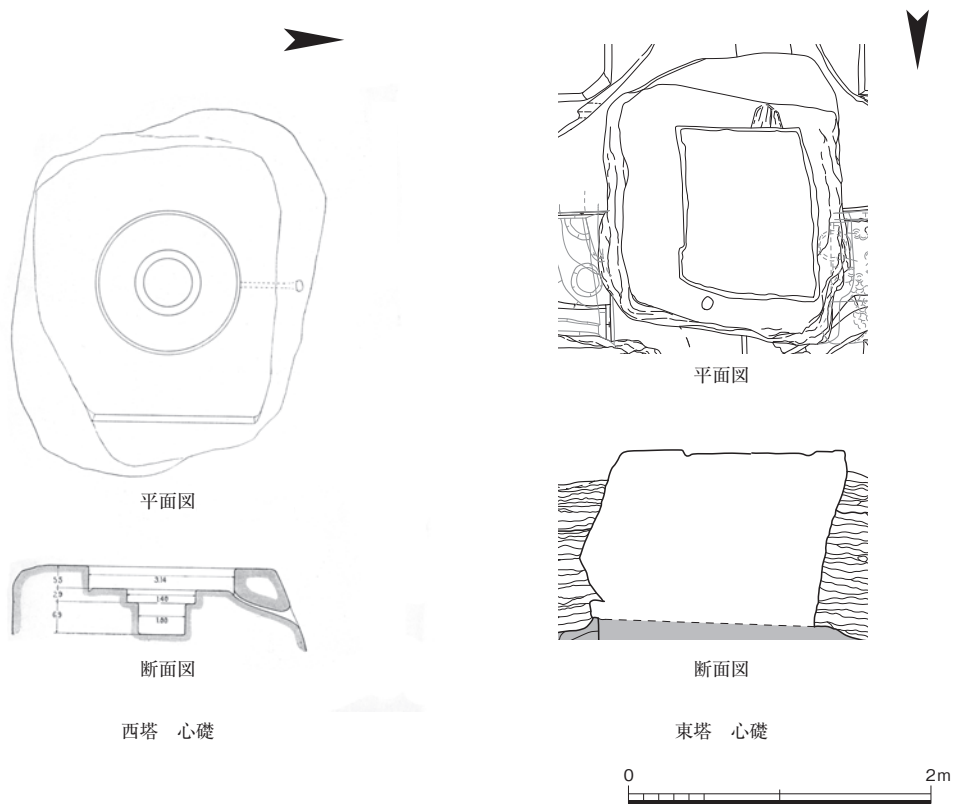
薬師寺(平城)東西塔心礎 平面図・断面図 1:50
